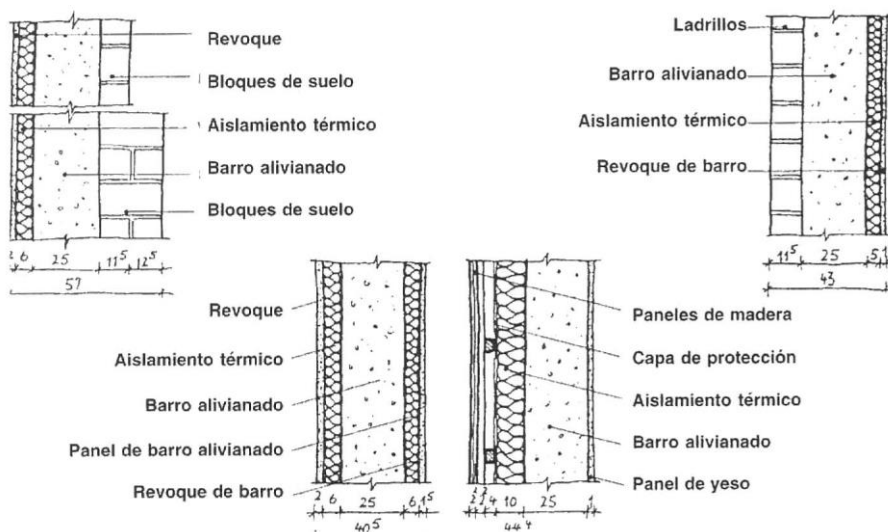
Secciones verticales de muros de barro alivianado apisonado con encofrado perdido (aislamiento y bloques de suelo) en ambas caras.
